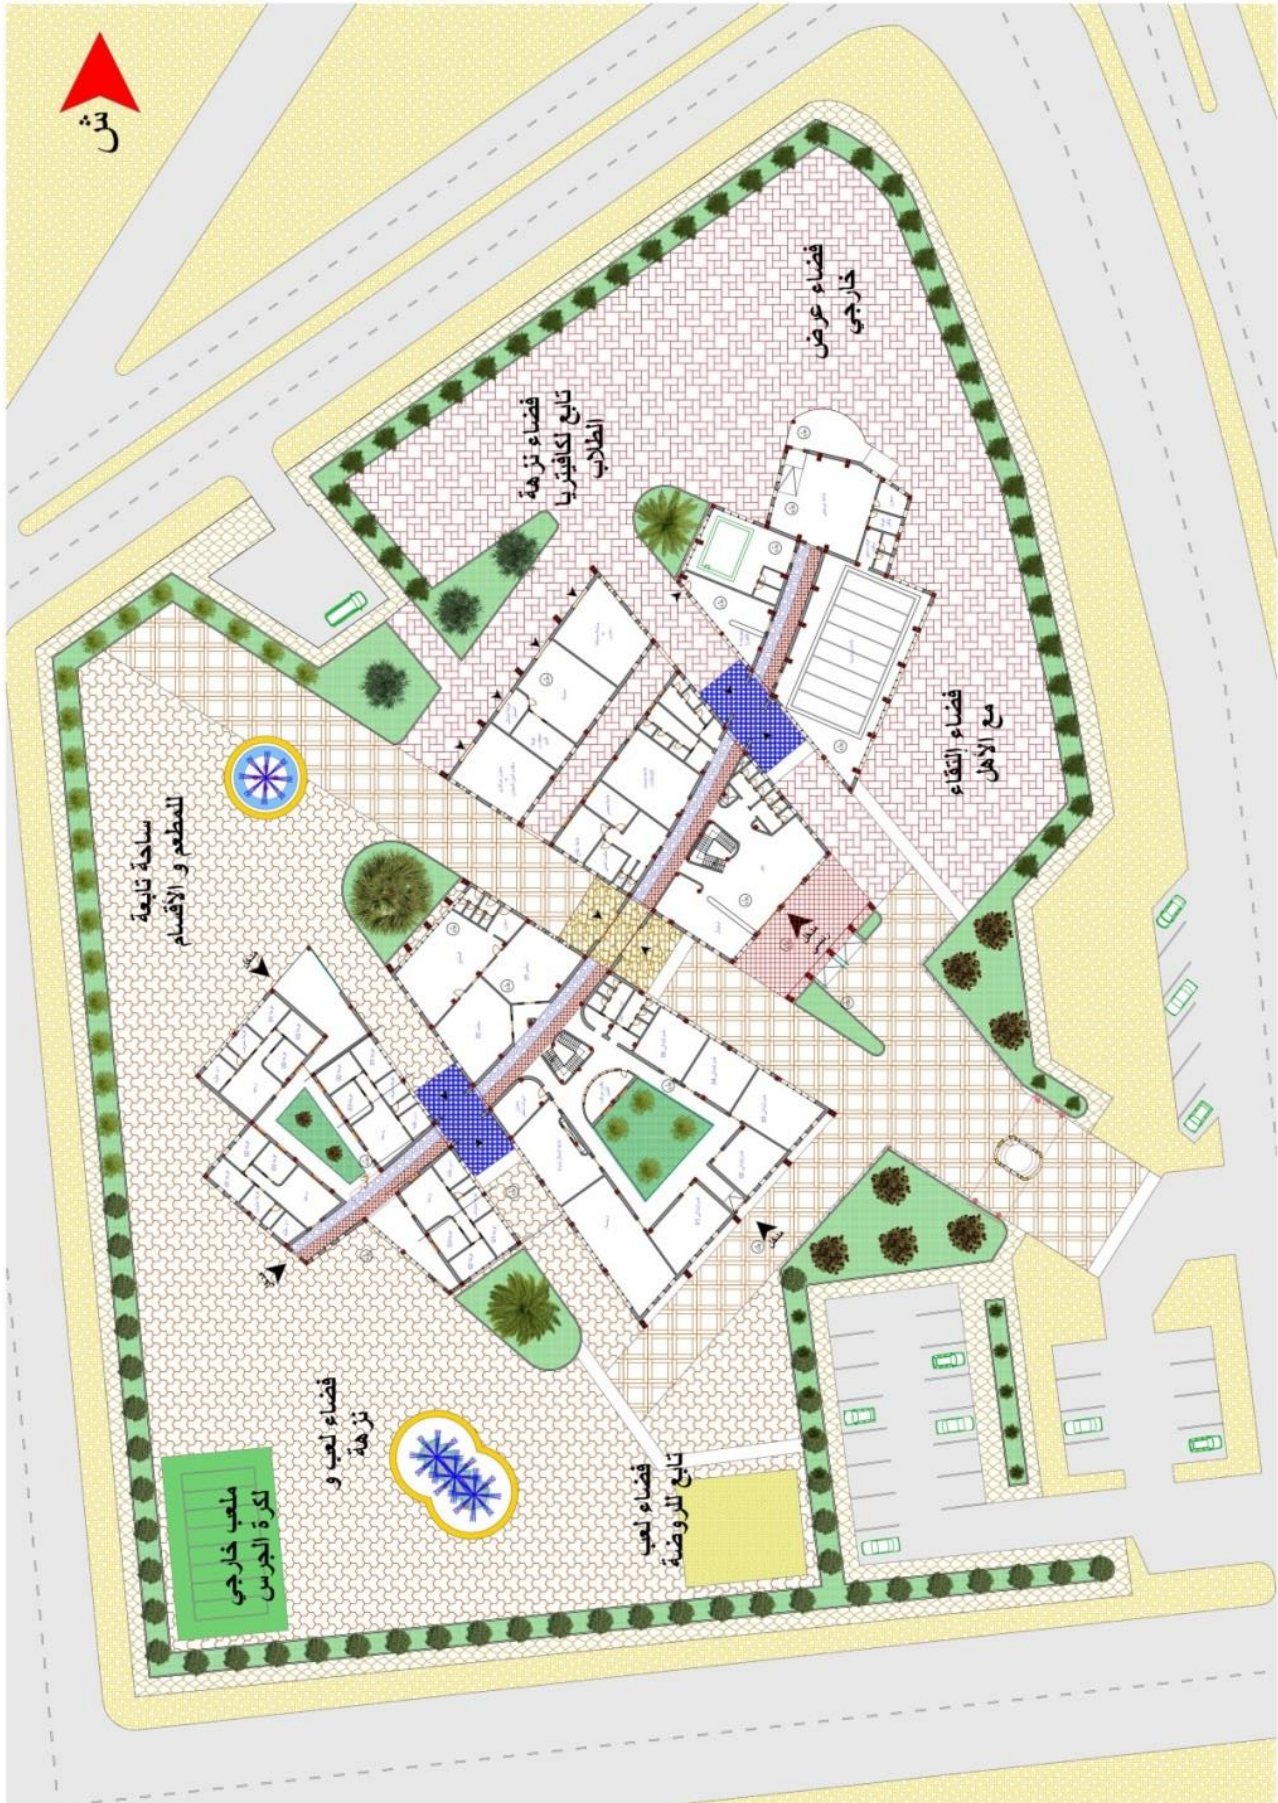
مخطط الطابق الأرضي سلم: 1/540.
